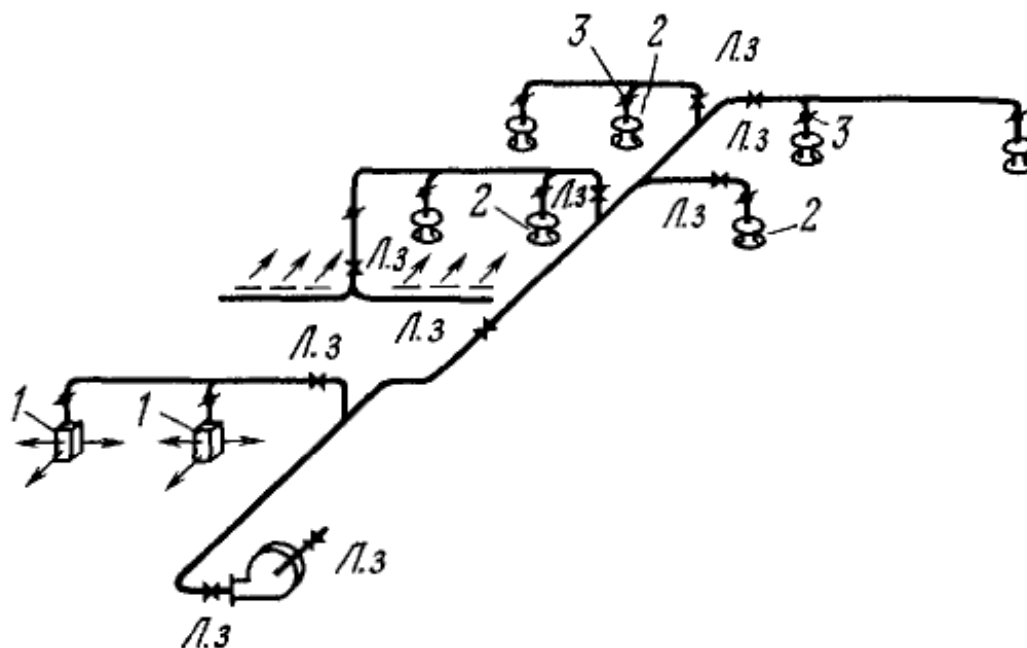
Схема вентиляционной системы с лючками для замера давлений воздуха:
